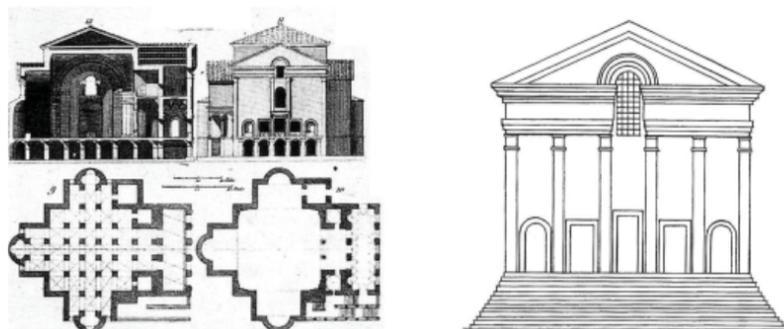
Zentralbau, Kirchenraum S. Sebastiano, Mantua, Grundriss, Schnitt, Ansicht
